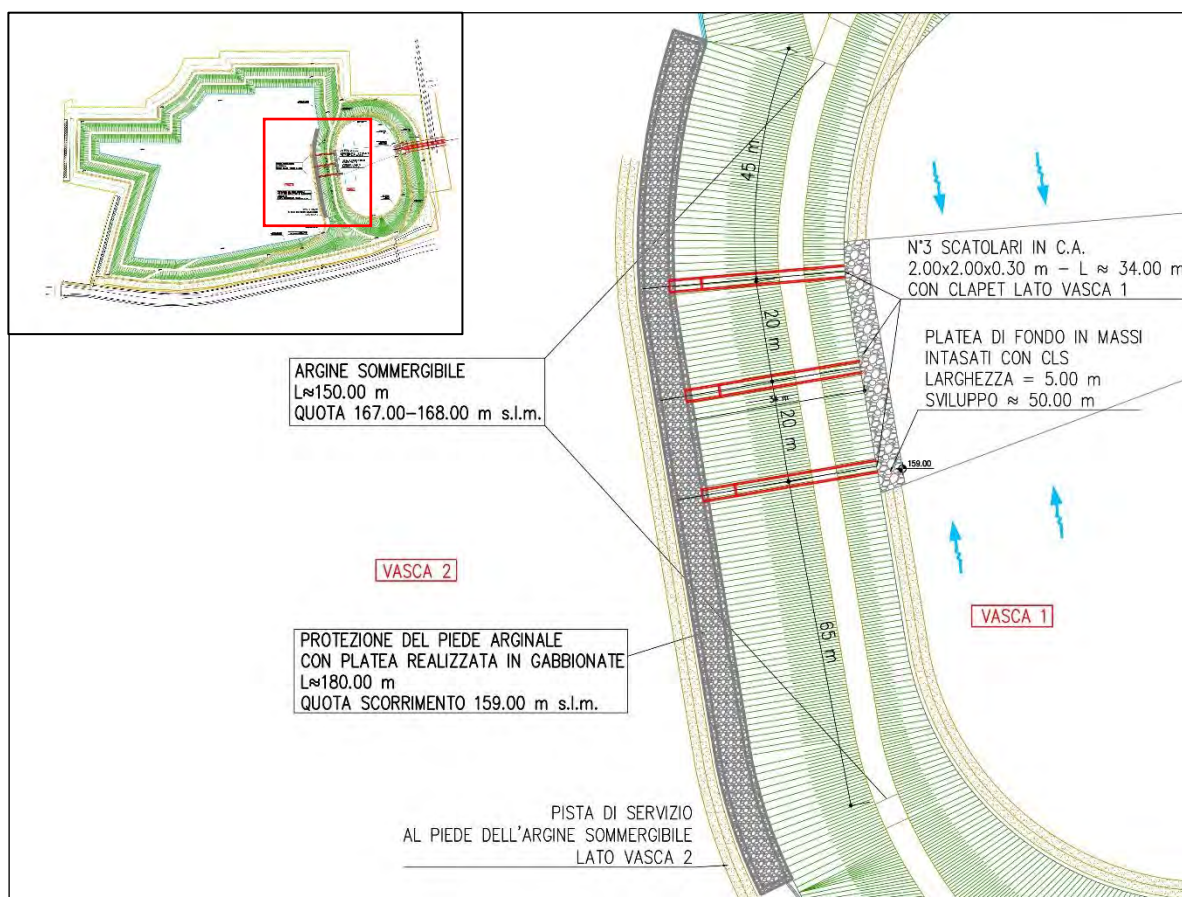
Planimetria area di laminazione e dettaglio argine intermedio.
